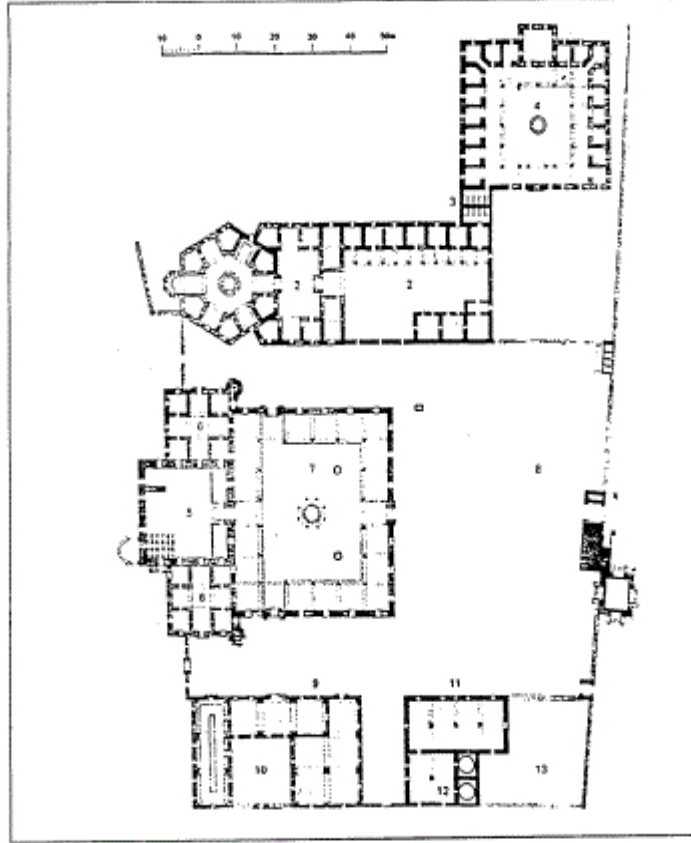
مسقط أفقي لمسجد بايزيد الأول في برجامة (عن: إيفردى)
